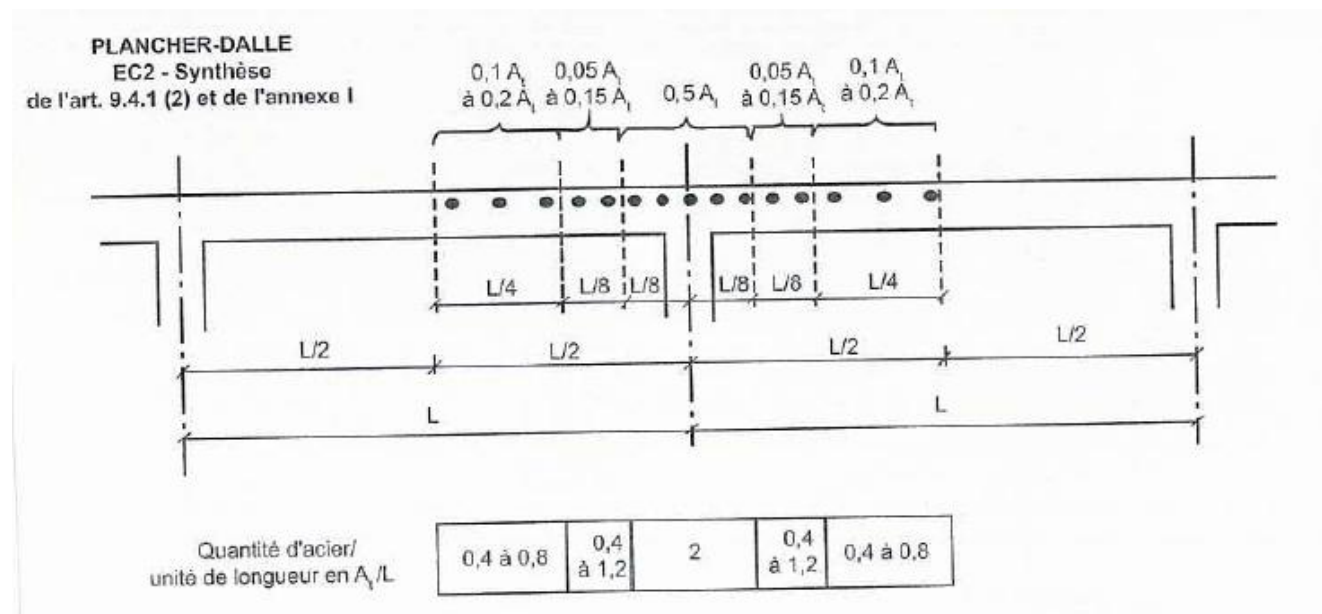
Planchers-dalles – Synthèse des règles de ferrillage
